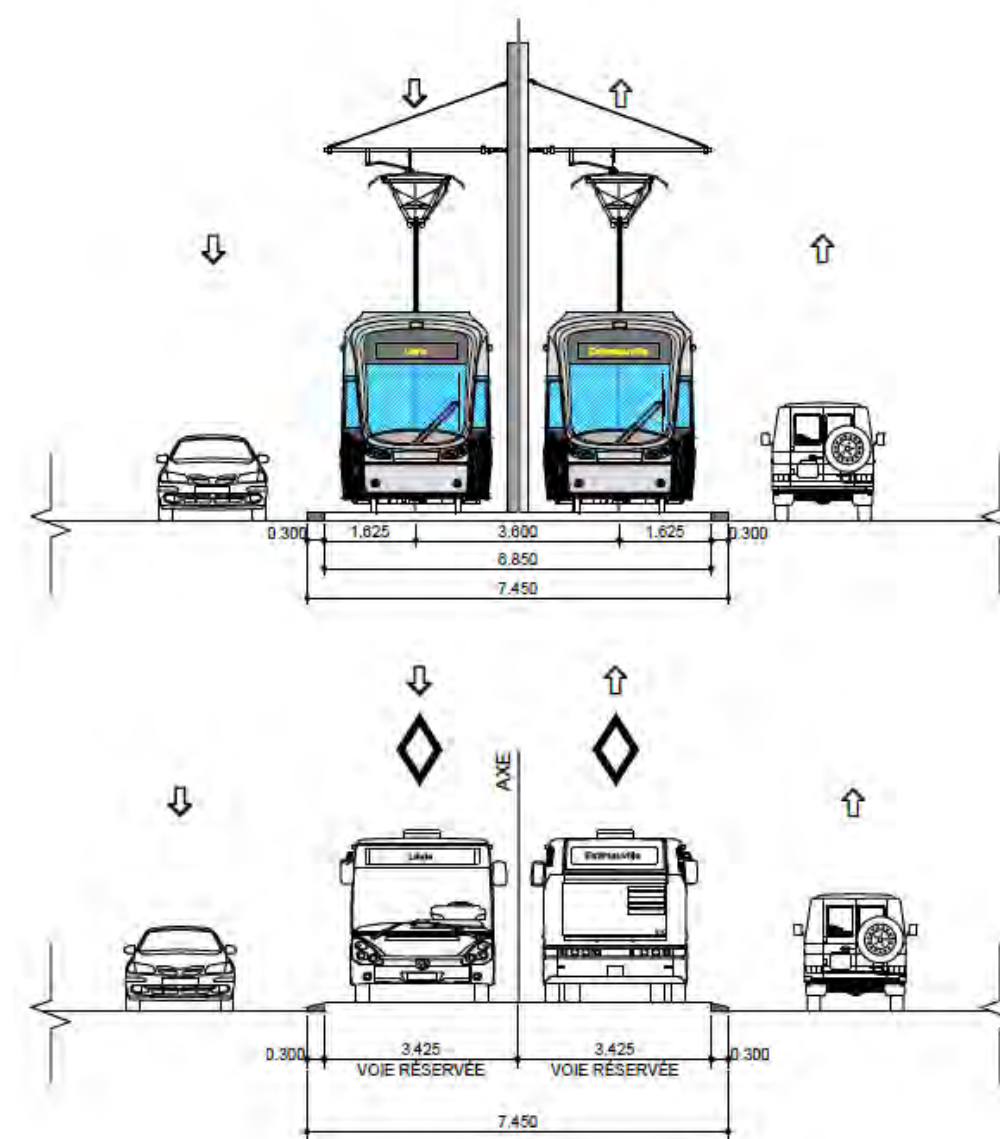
Coupe type 03 de 15 - SRB - Site espace restreint - Insertion axiale semi-franchissable
